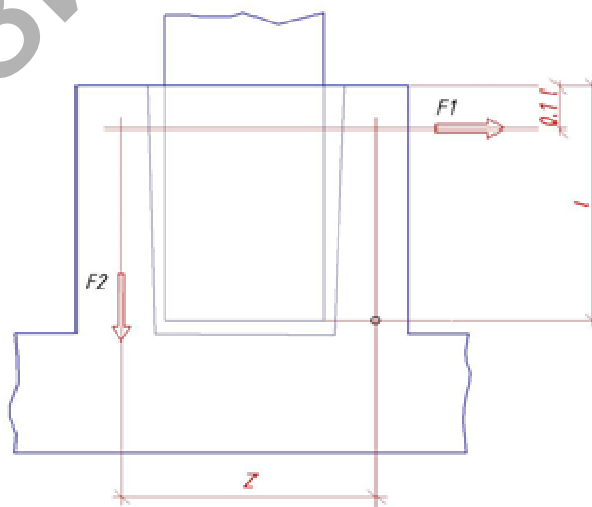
Расчетная схема для определения вертикальной арматуры стакана
